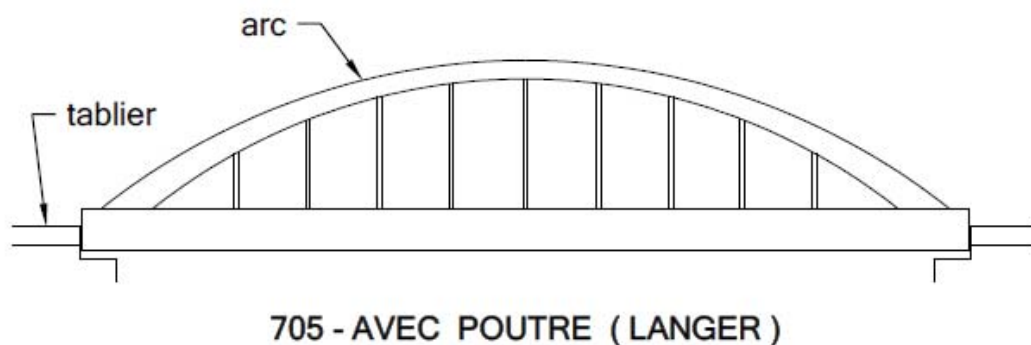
Schéma d'une structure à tablier inférieur à arc avec poutre de type Langer
